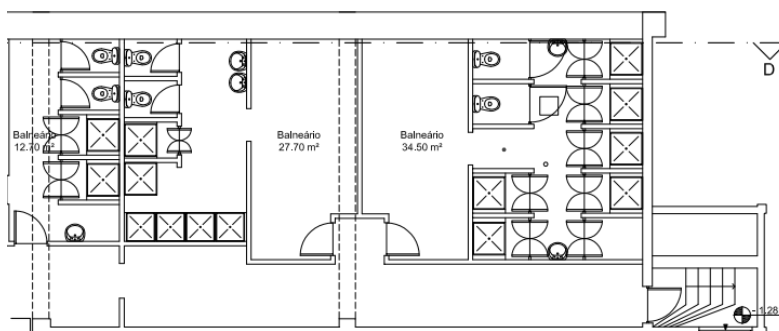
Secção da planta da zona de balneários do Pavilhão n°1 da UBI – s/ escala
